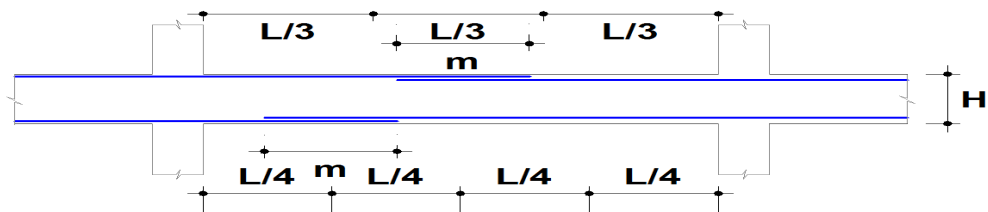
a. Detalle empalme por traslape del refuerzo
